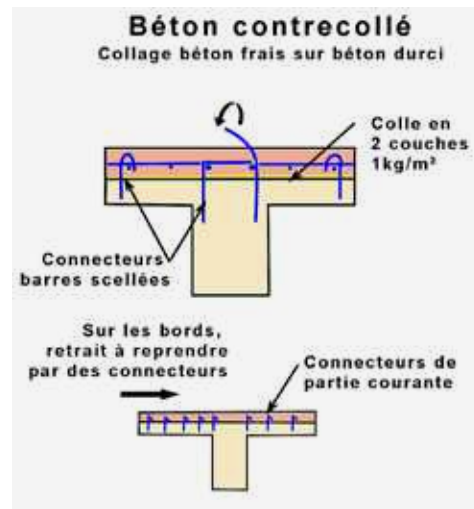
principe de réalisation d'un renforcement d'une dalle et d'une poutre par béton contrecollé
